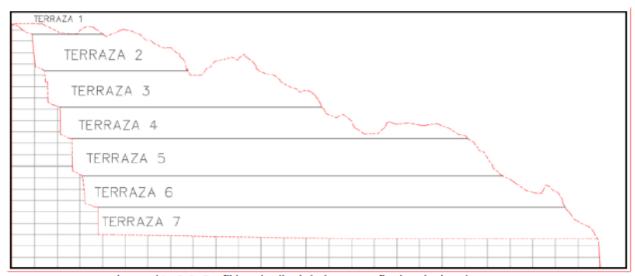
Perfil longitudinal de banqueo final y niveles de terrazas
